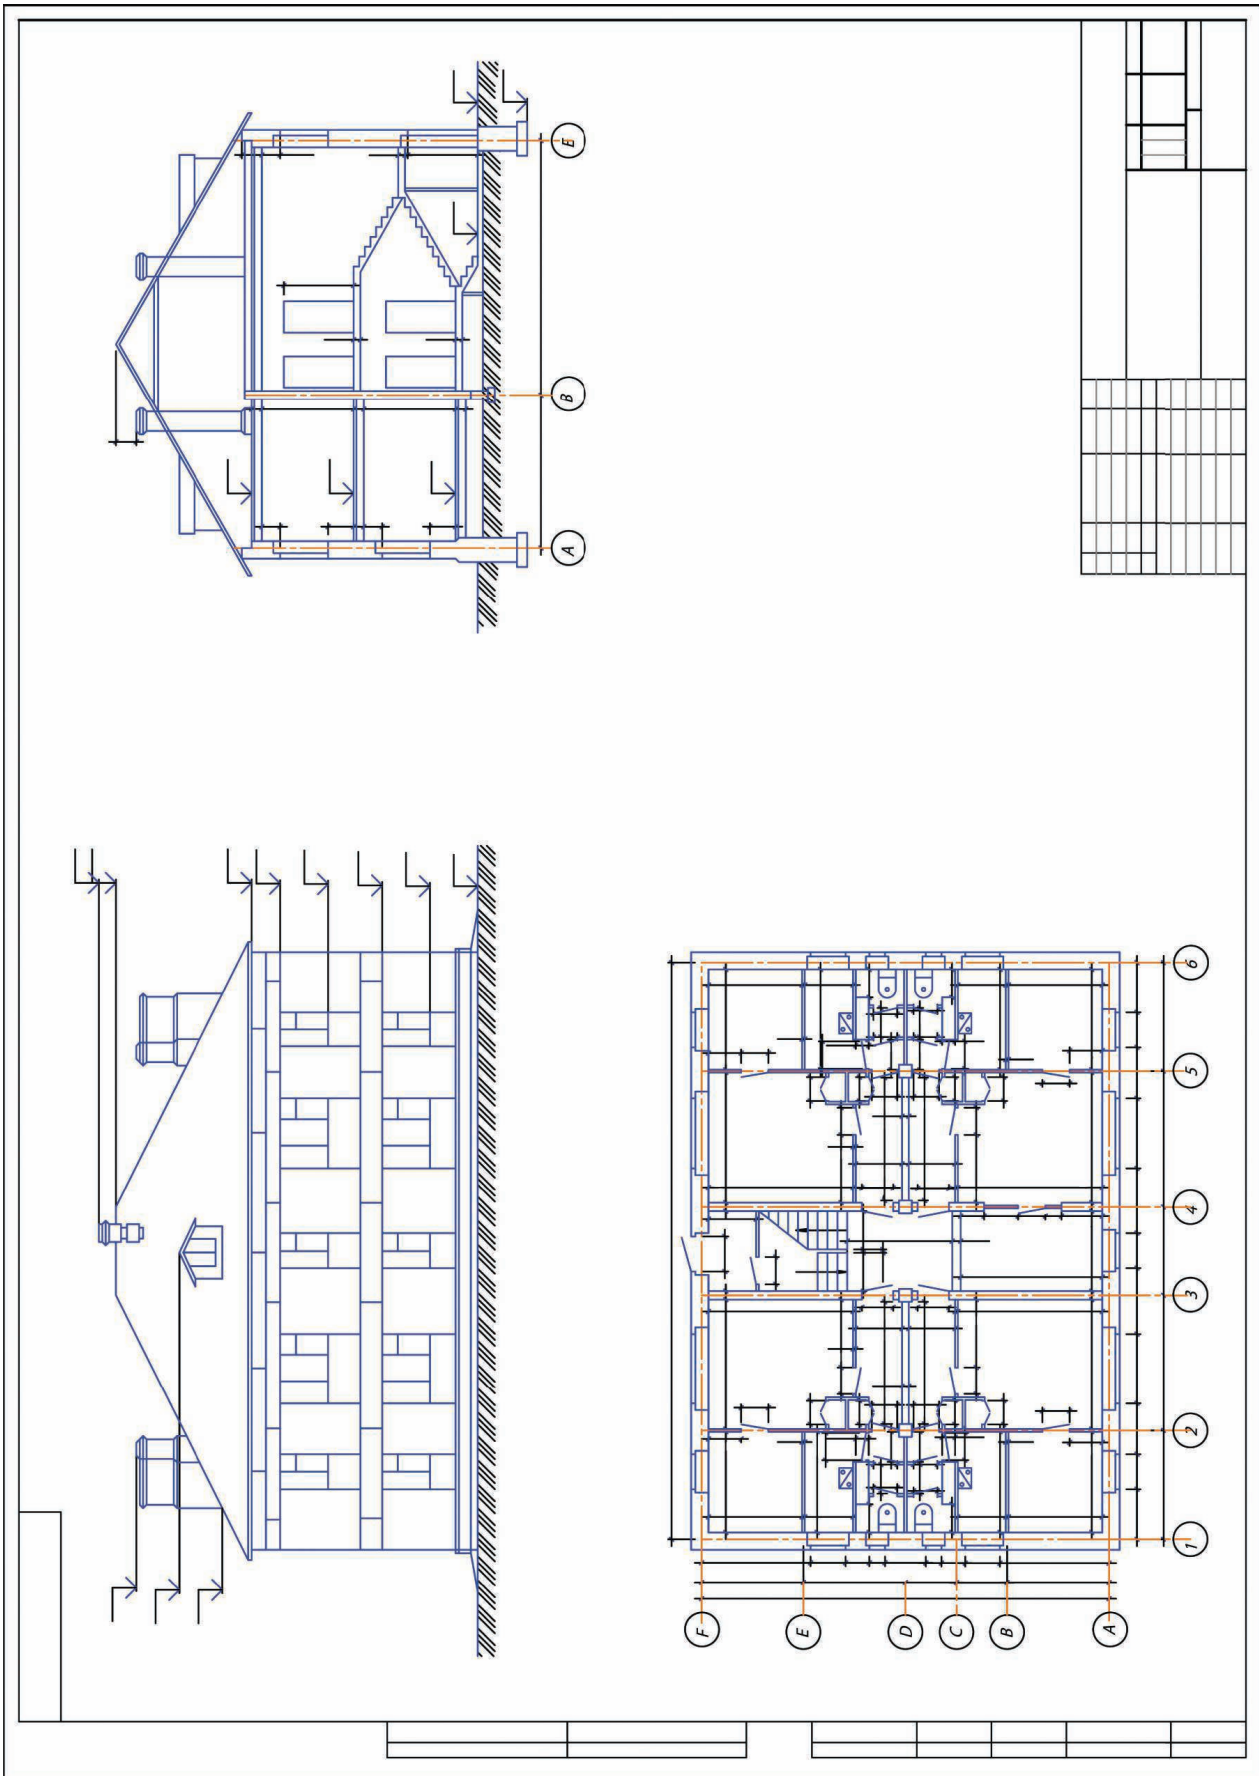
В проектной документации обязательно должен быть план каждого этажа, разрез и фасад здания
